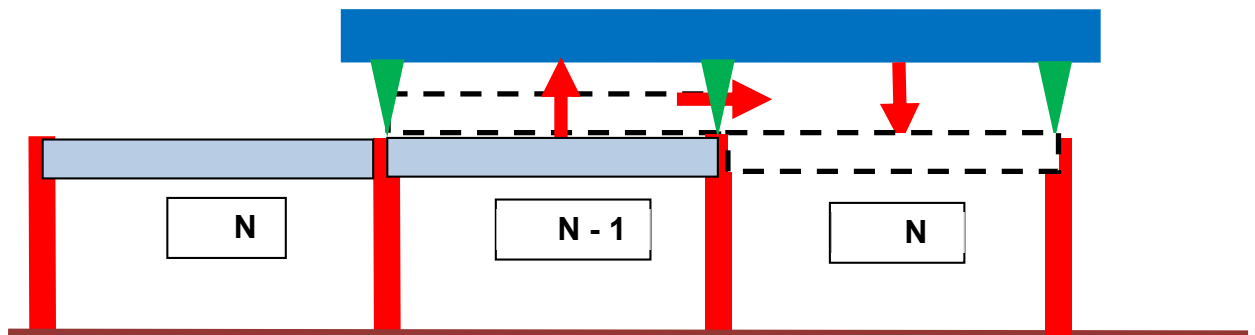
Esquema conceptual del montaje con viga de lanzamiento
